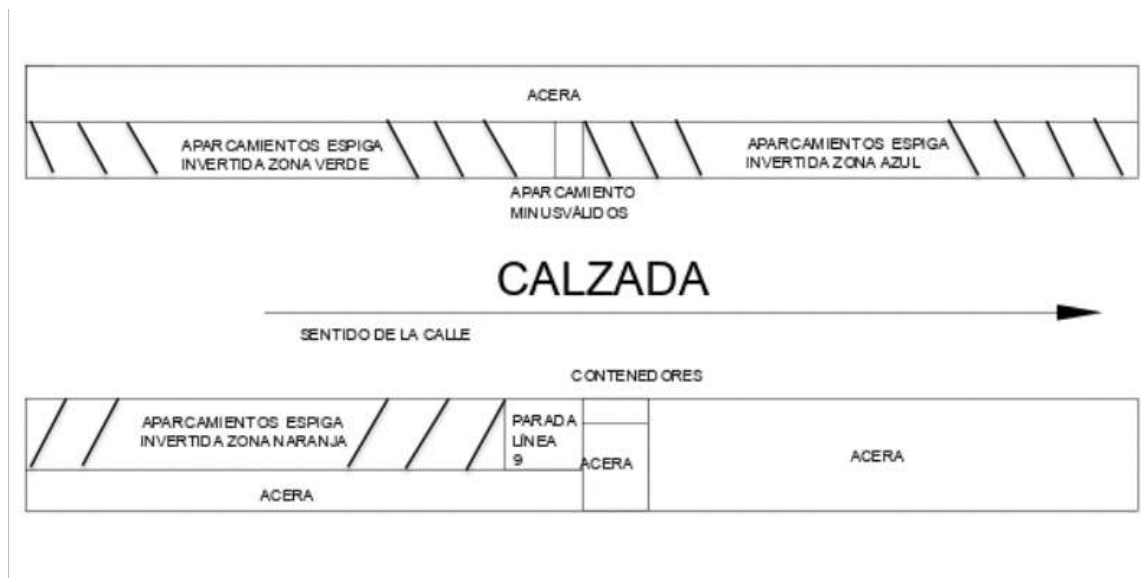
Esquema de como quedaría la calle en planta. Fuente: Elaboración propia.
